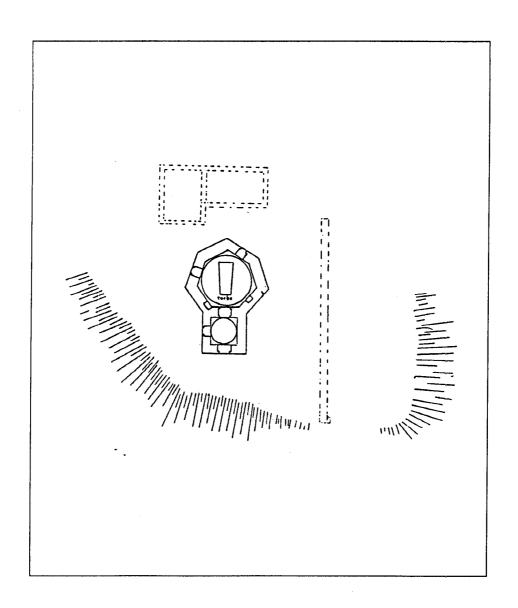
مسقط أفقي لتربة السليمانية بإستانبول (عن : اصلان ابا) .
